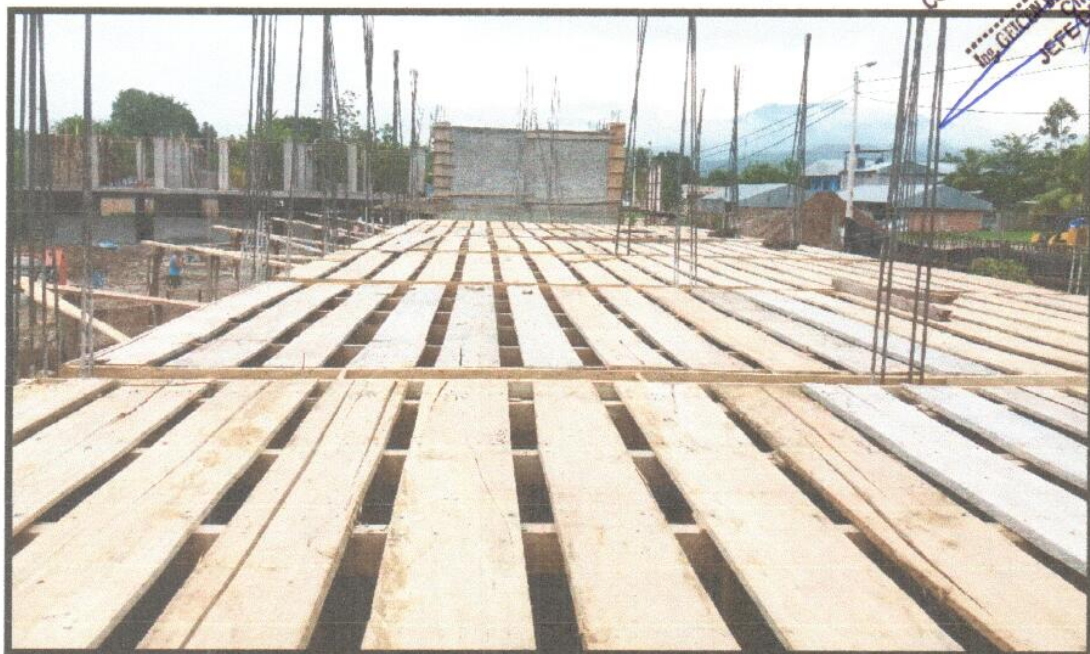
ENCOFRADO DE LOSA ALIGERADA. MODULO 01
